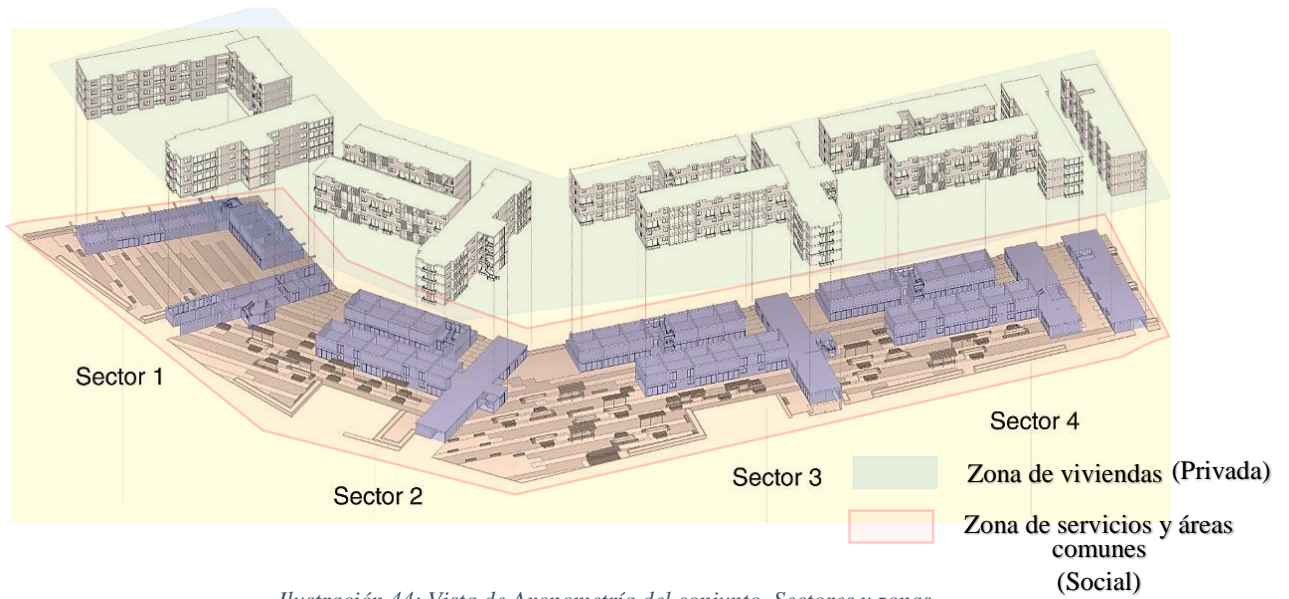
Vista de Axonometría del conjunto. Sectores y zonas.
